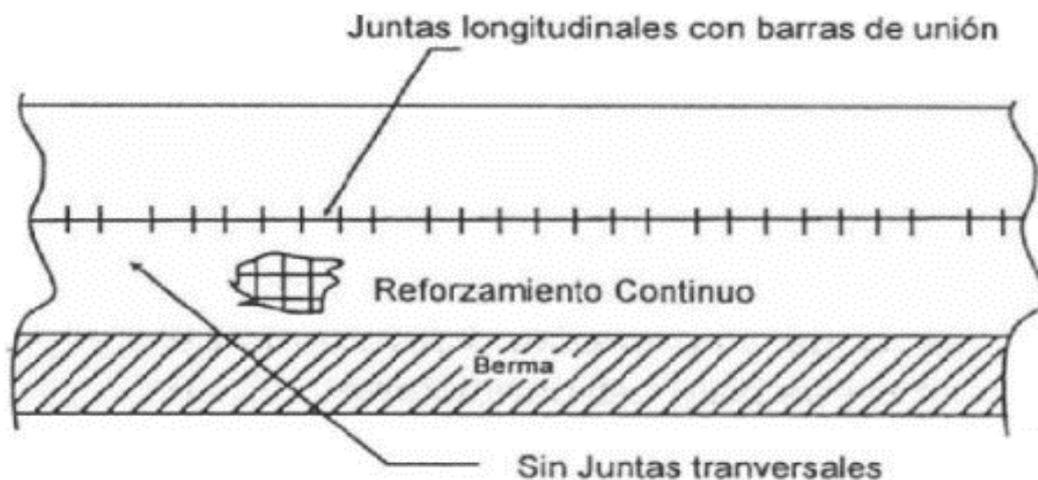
La composición del pavimento continuo de concreto reforzado. [15]
